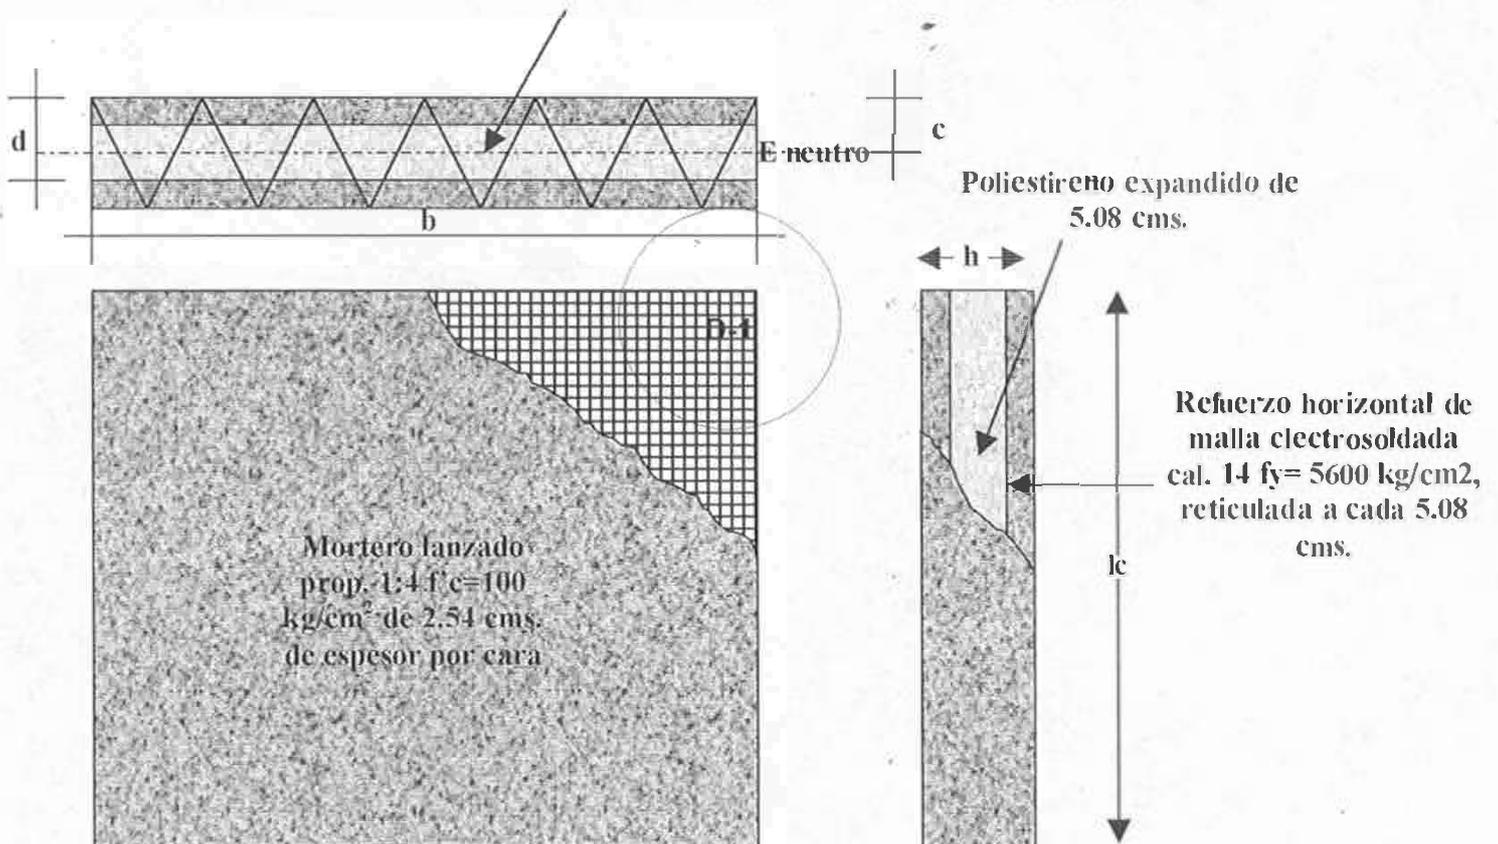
Planta, alzado y corte de muro de panel de poliestireno expandido reforzado con tridiestructura de alambre de acero.
